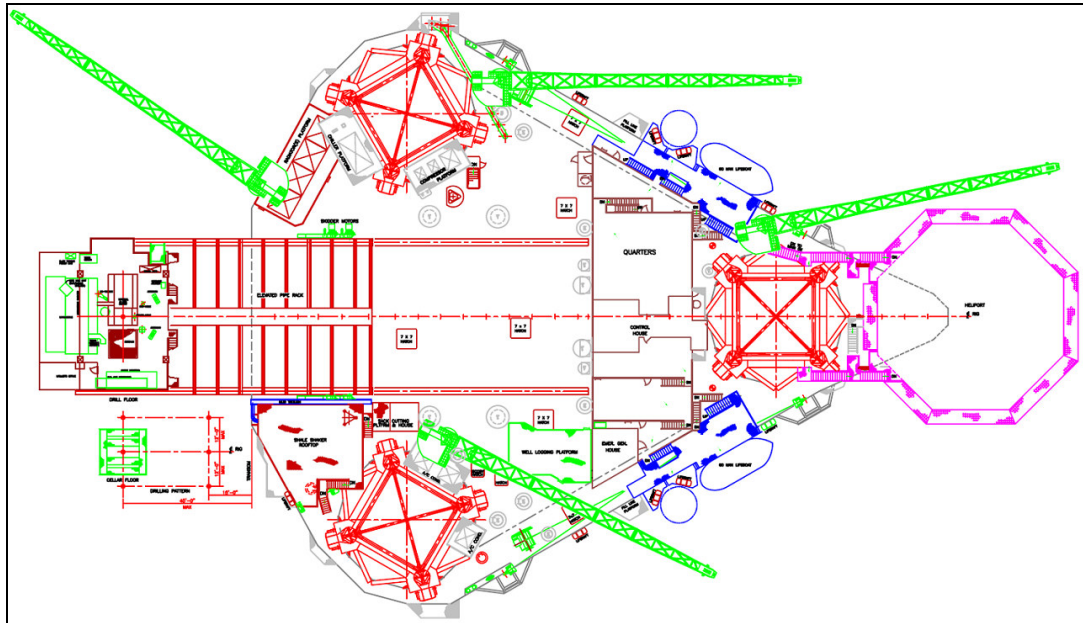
planimetria Impianto Jack-Up Drilling Unit (GSF Key Manhattan - Vista dall'alto del piano principale)
